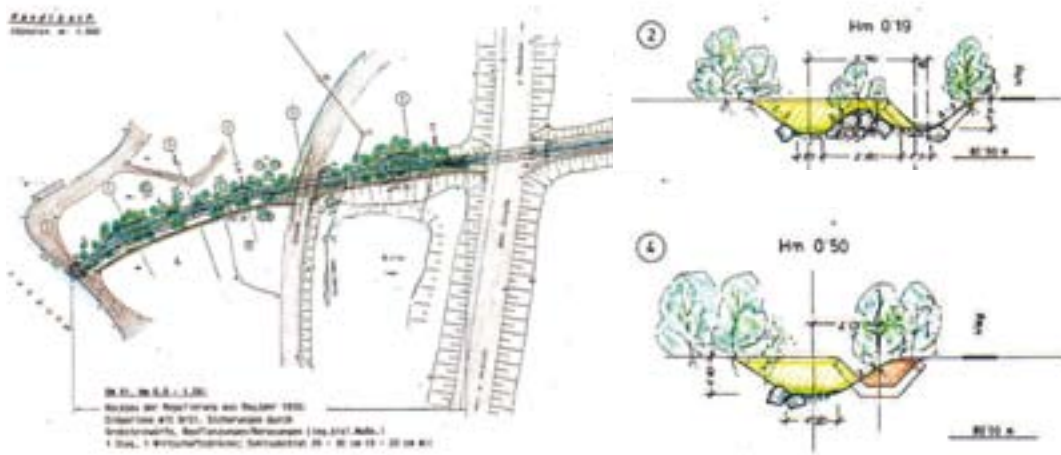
Lageplan und Detailprofile der Renaturierungsstrecke aus dem Jahr 2000.
